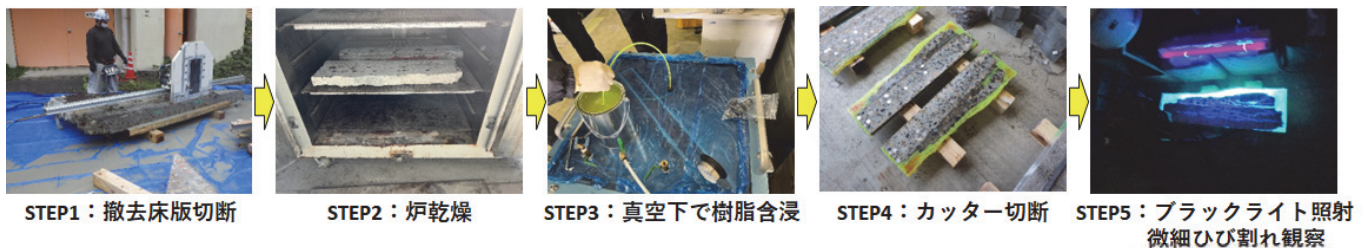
コンクリート板の微細ひび割れ観察手順
